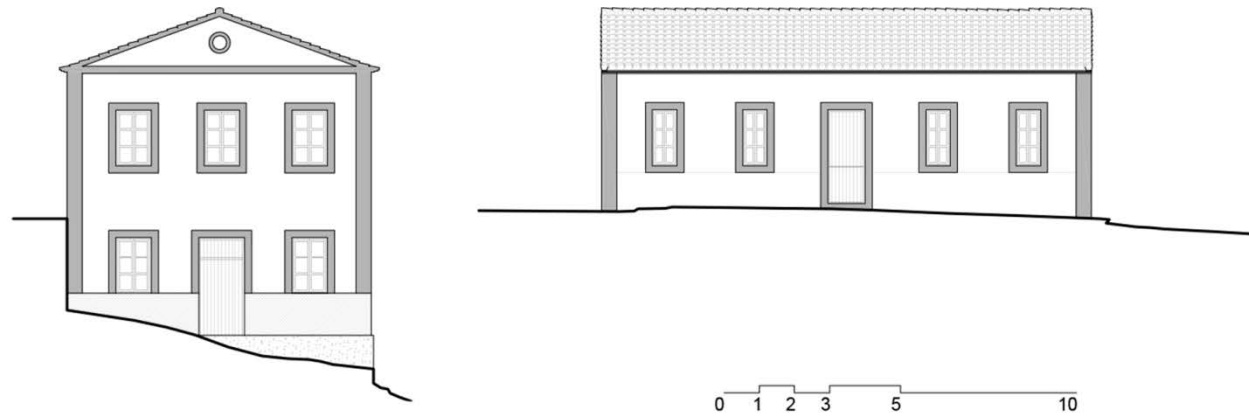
Levantamiento Planimétrico del Pabellón de Administración, Hospedería. Fase 1 (1907-1922).
